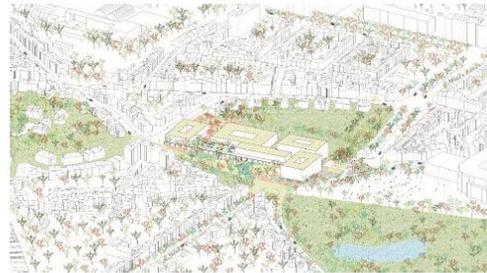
Master plan du site hospitalier Bracops (Source: archipelago architects)
